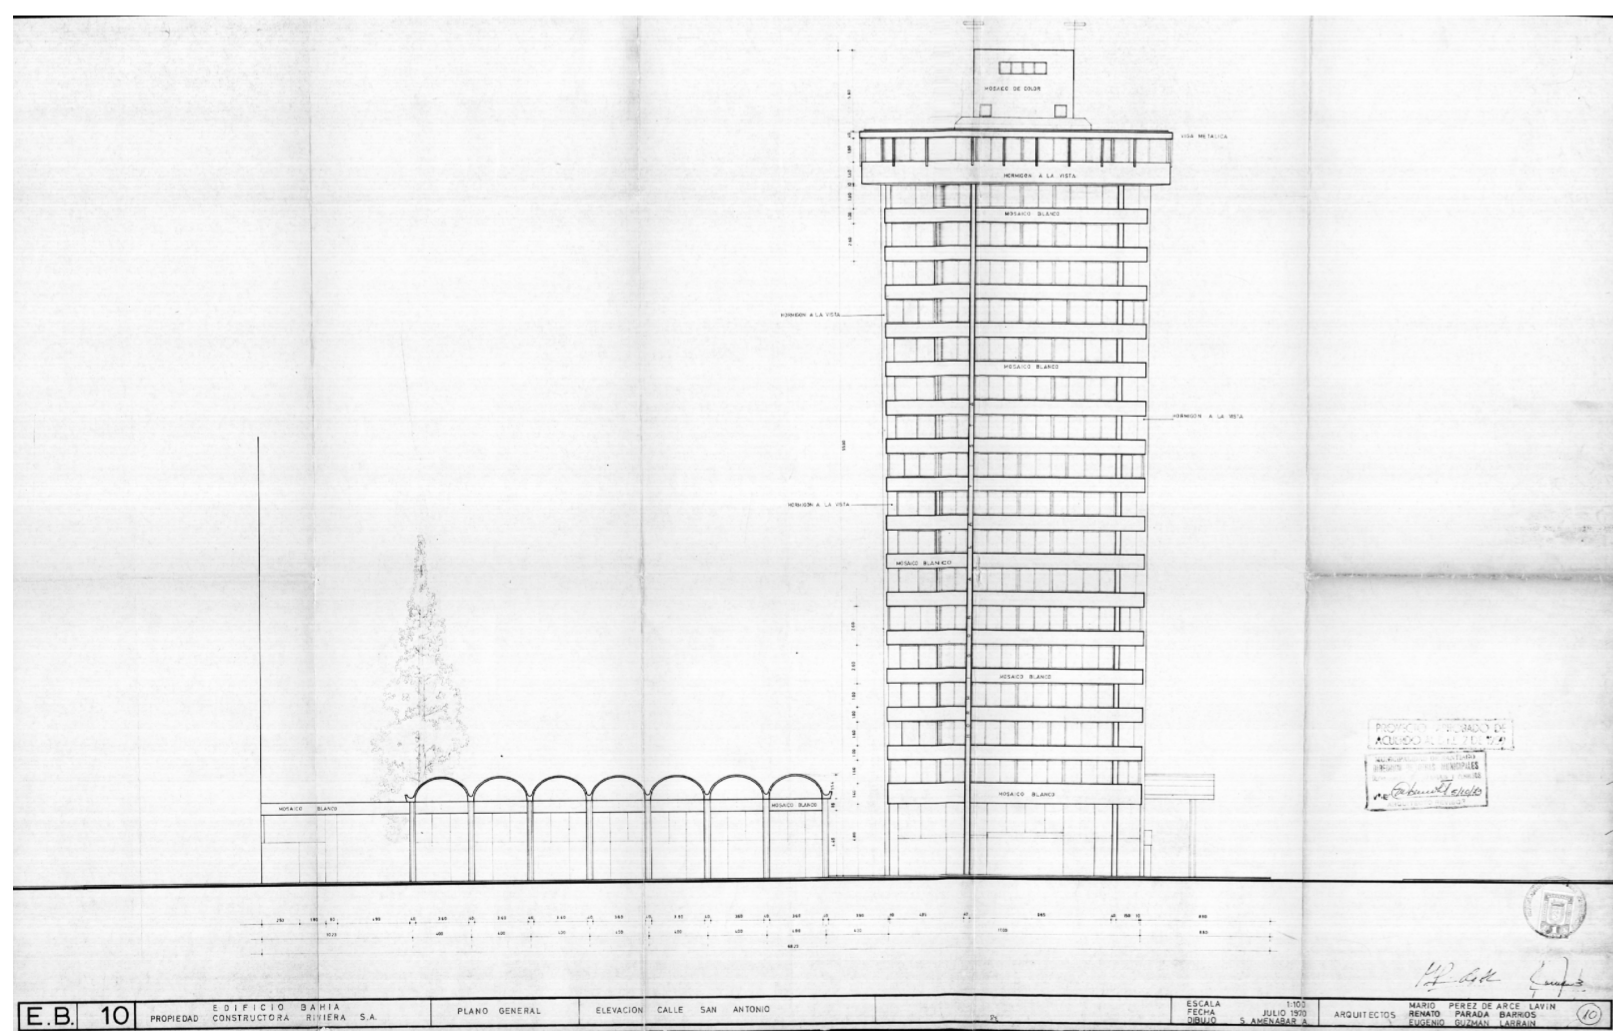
Archivo Plano Municipal. Vista calle San Antonio.
